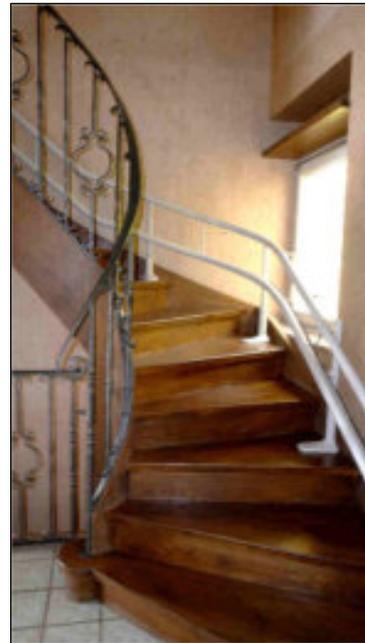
Treppe Erd-Dachgeschoss Haus 93
